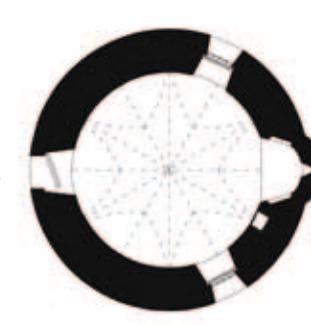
Grundriss Kappel am Krappfeld, M 1:200. TU Graz/Modritscher, Wimmer 2008.
